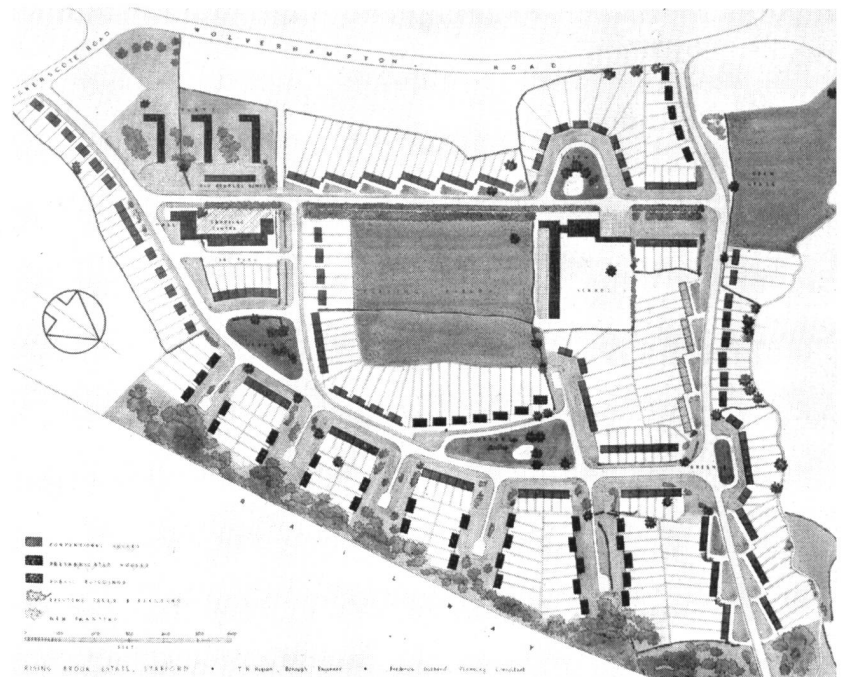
Wohnkolonie in England um eine Schulhausanlage gruppiert. Dunkelgrau: Bauten in Massivbauweise. Schwarz: Bauten in der Notbauweise. Durch die lockere Ueberbauung und die Mischung beider Bauweisen wird vermieden, dass die Siedlung zu einer Barackenstadt wird.
